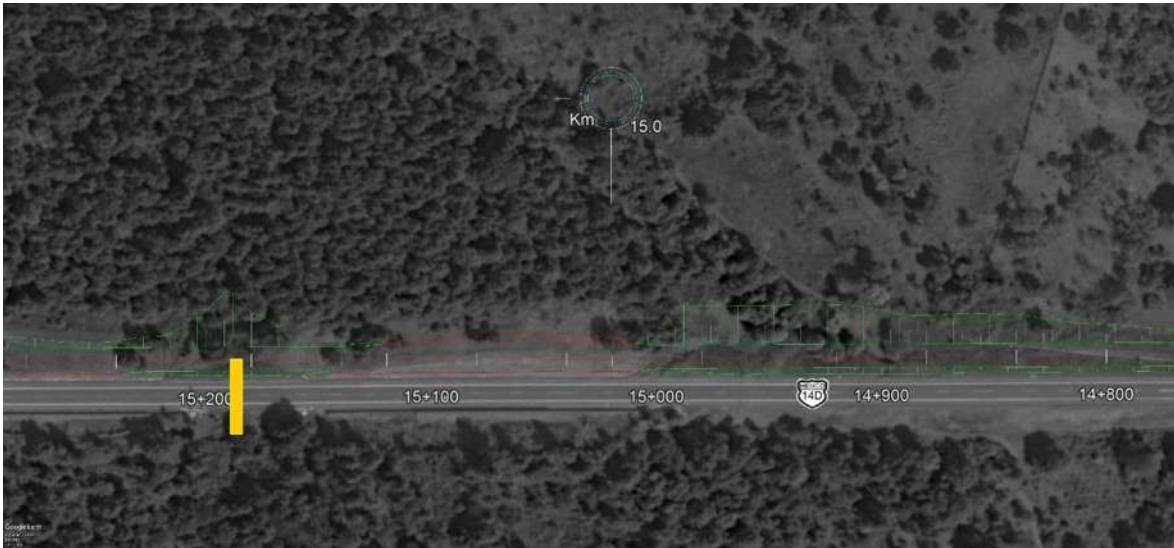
Ubicación de obra existente en tangente y zona de terraplén, corresponde a un doble tubo de concreto km. 14+939.49.
